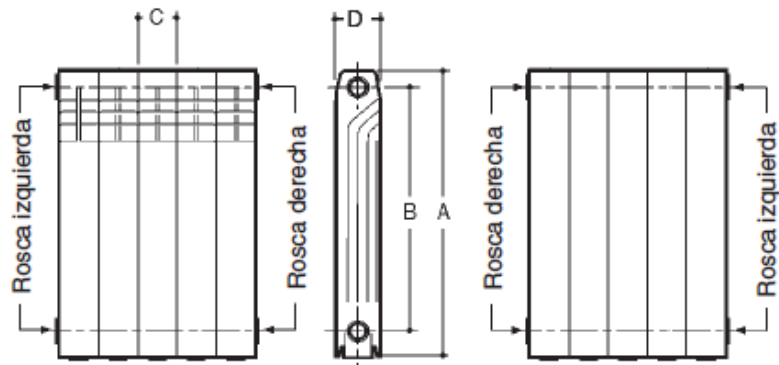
Dimensions Radiadors Calefacció BAXIROCA - Dubal
